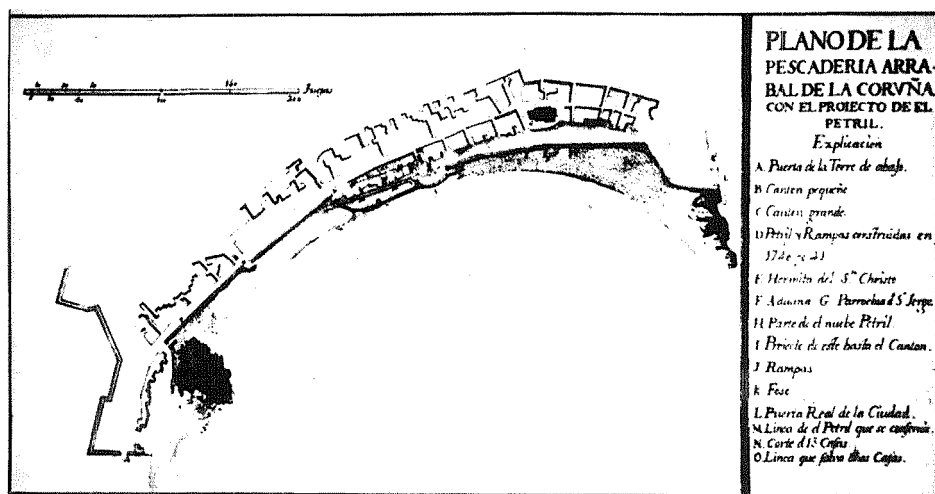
“Plano de la Pescadería arrabal de La Coruña con el proyecto de el petril”: muro portuario entre el Cantón Grande y Puerta Real. Pedro Torbé, 1765 (A.G.S.).
